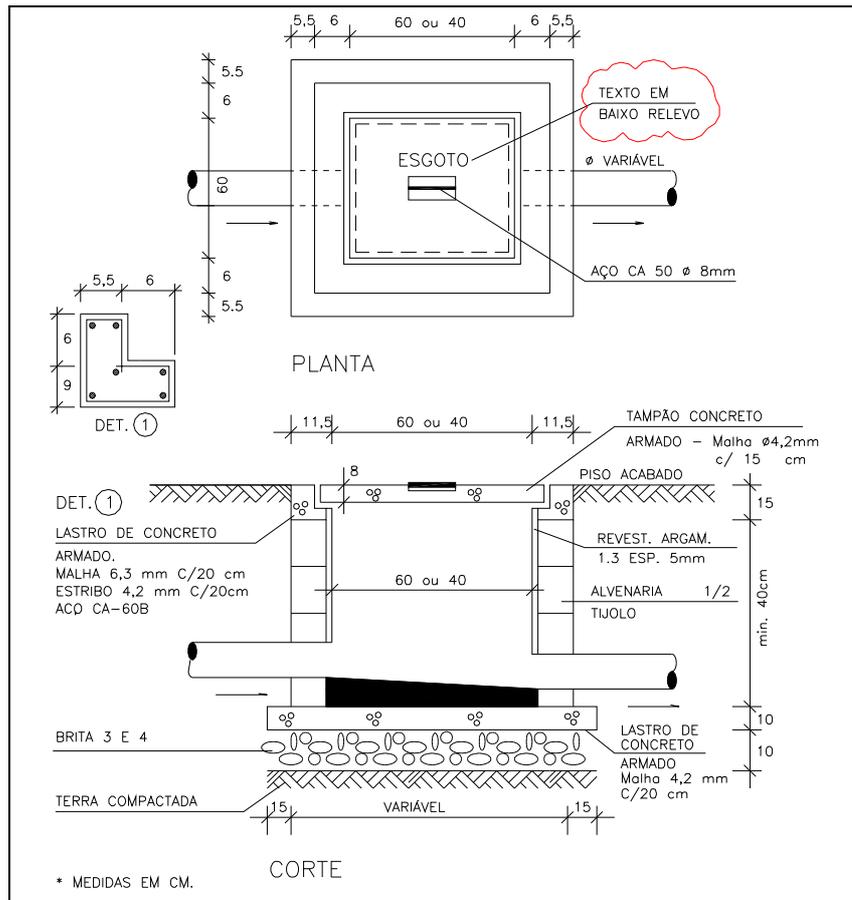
Detalhe executivo de caixas de inspeção no Projeto B
